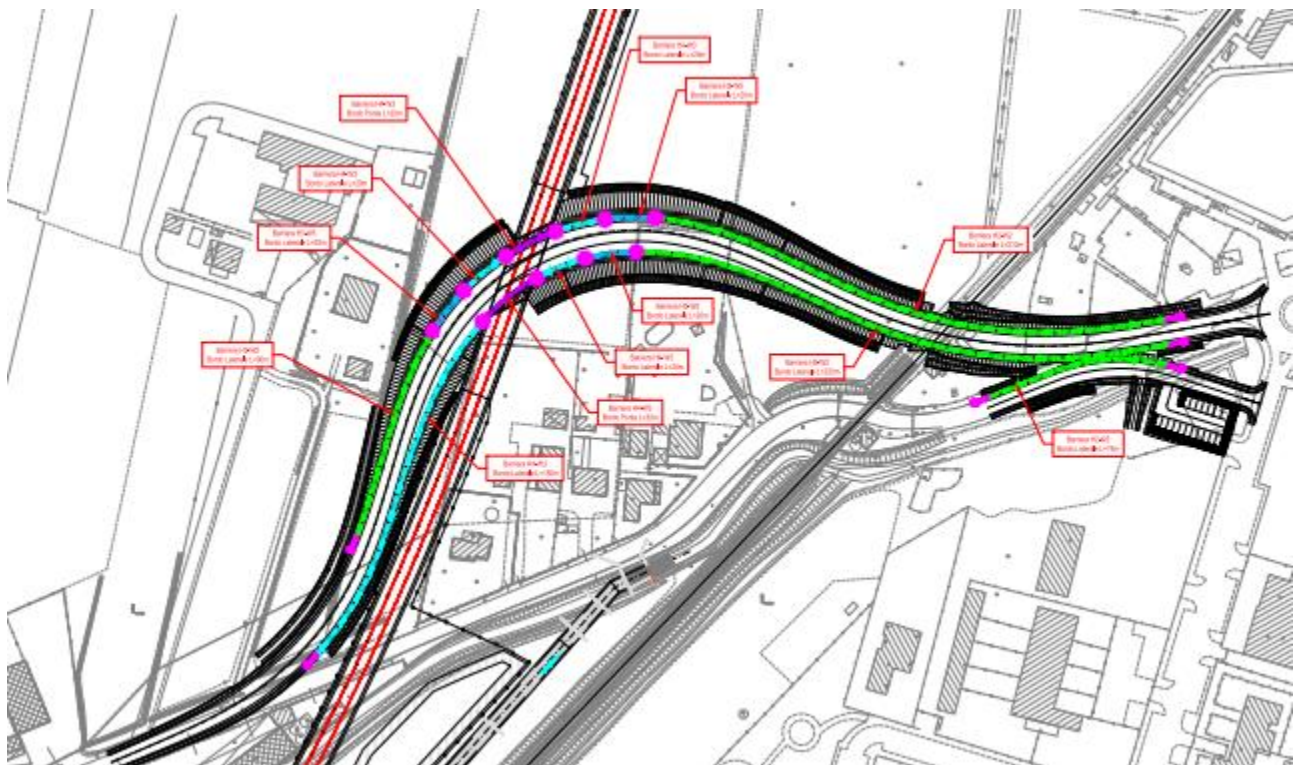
Stralcio planimetrico della tipologia di barriere lungo il tracciato della viabilità NV04
